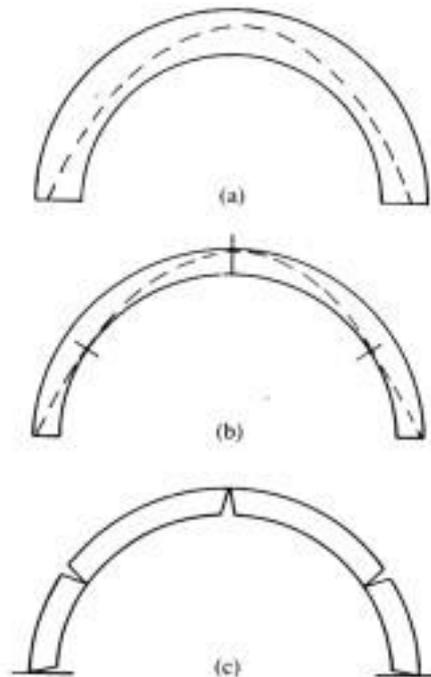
Fisuras en arco por apertura de apoyos.
